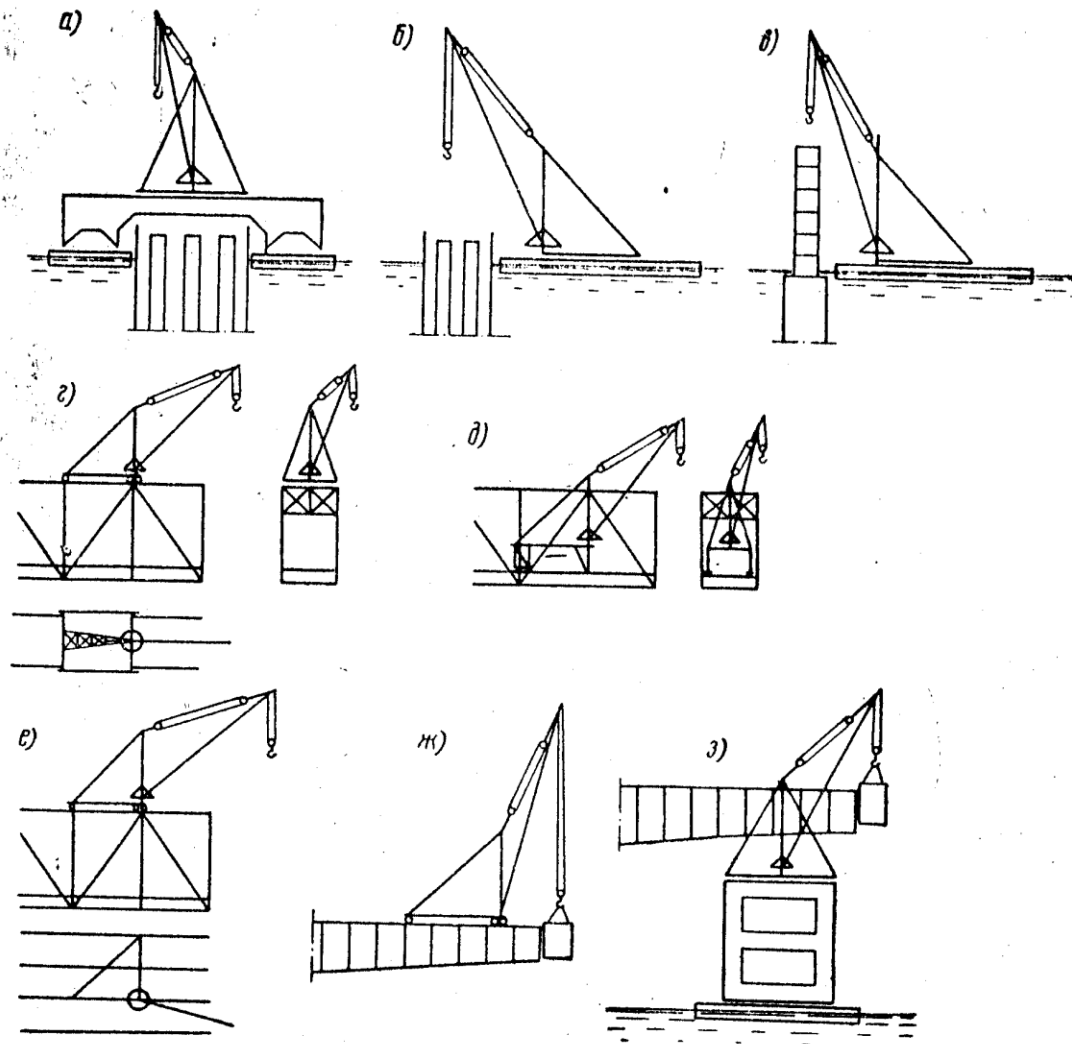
Схемы применения и установки жесткоопорных деррик-кранов: а и б — при сооружении сборных фундаментов опор; в — при монтаже сборных опор; г, д, е — при монтаже металлических пролетных строений; ж и з — при навесном монтаже железобетонных пролетных строений
